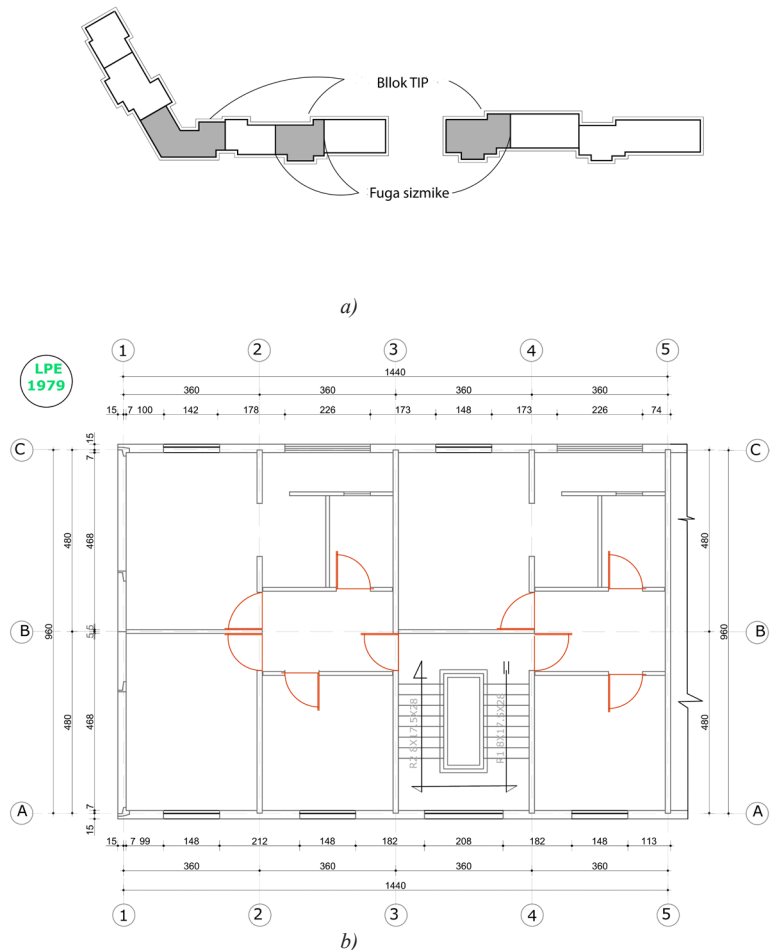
Planet arkitekturore për ndërtesa tipike shqiptare me pllaka beton arme të parafabrika: a) shembuj të plan organizimit të ndërtesave dhe b) Planimetria e një blloku tipik ndërtimi (Tipi-1) (burimi: AQTN).
